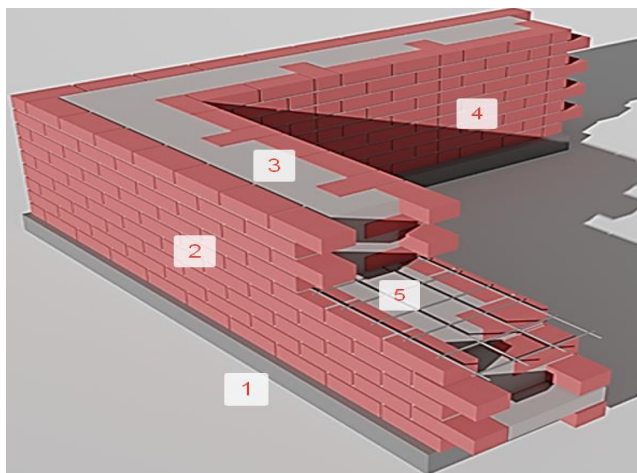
Фрагмент колодезной кладки из фибропенобетонной смеси: 1 – фундамент; 2 – фибропенобетонный блок облицовочный; 3 – пенокомозит; 4 – внутренний фибропенобетонный блок; 5 – арматурная сетка
